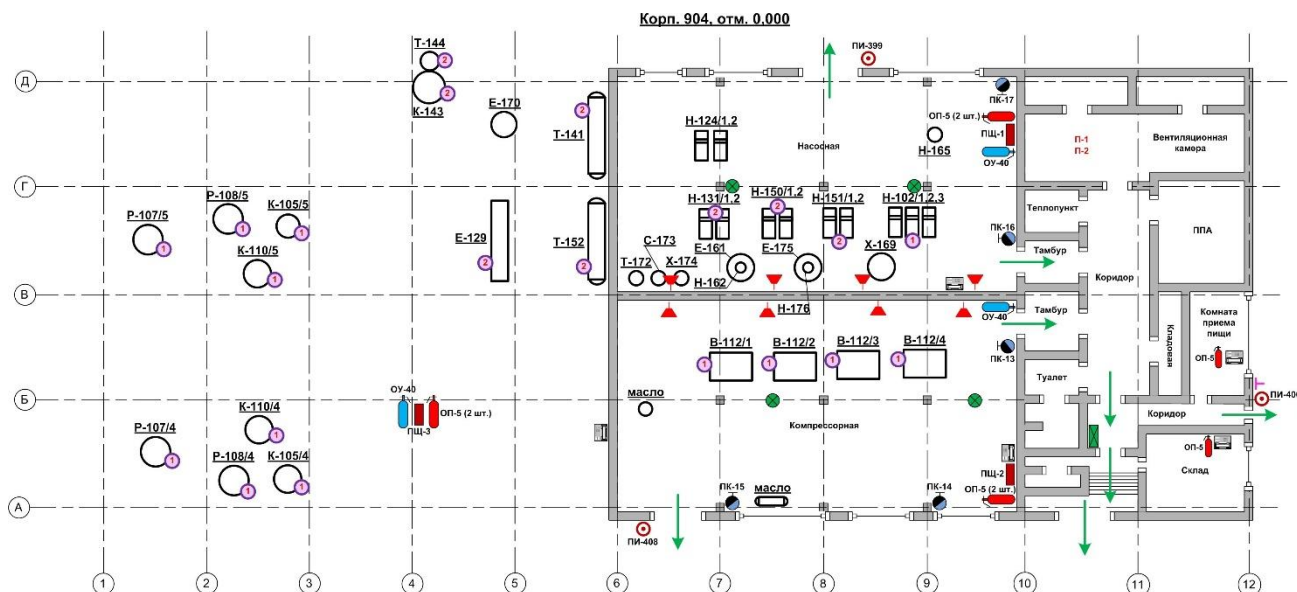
План цеха 22 корпуса 904 на отм. 0.000
